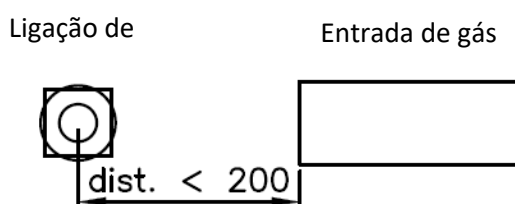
Distância mínima de soldadura a gás à instalação
